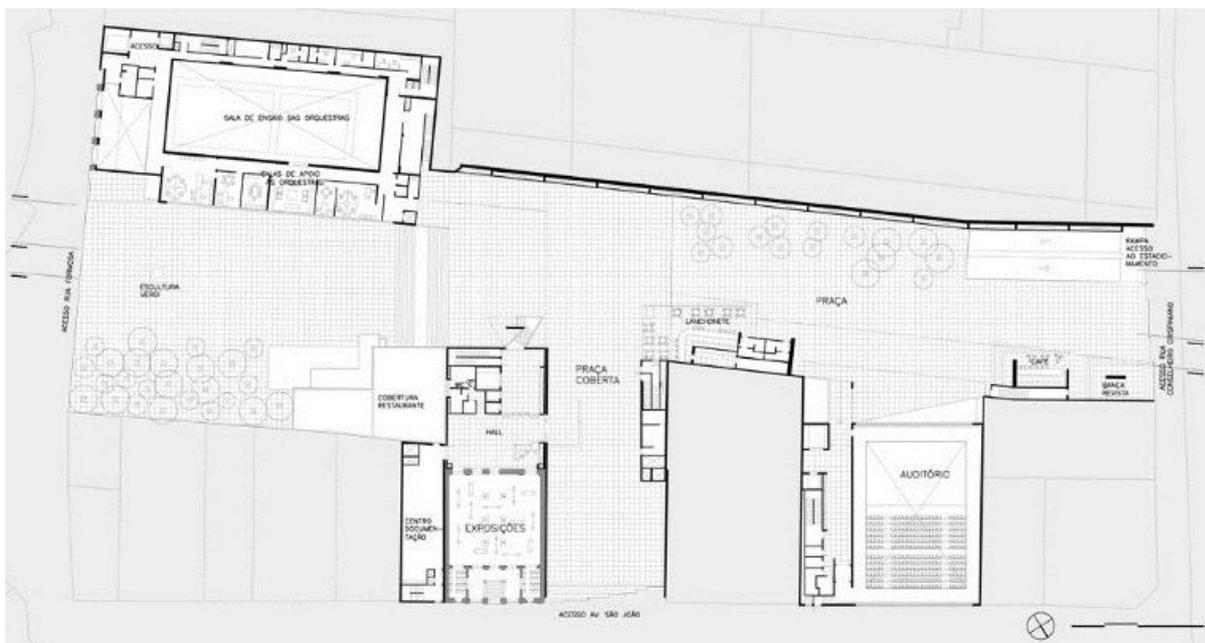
Planta do pavimento térreo (FONTE: Archdaily, 2013).
